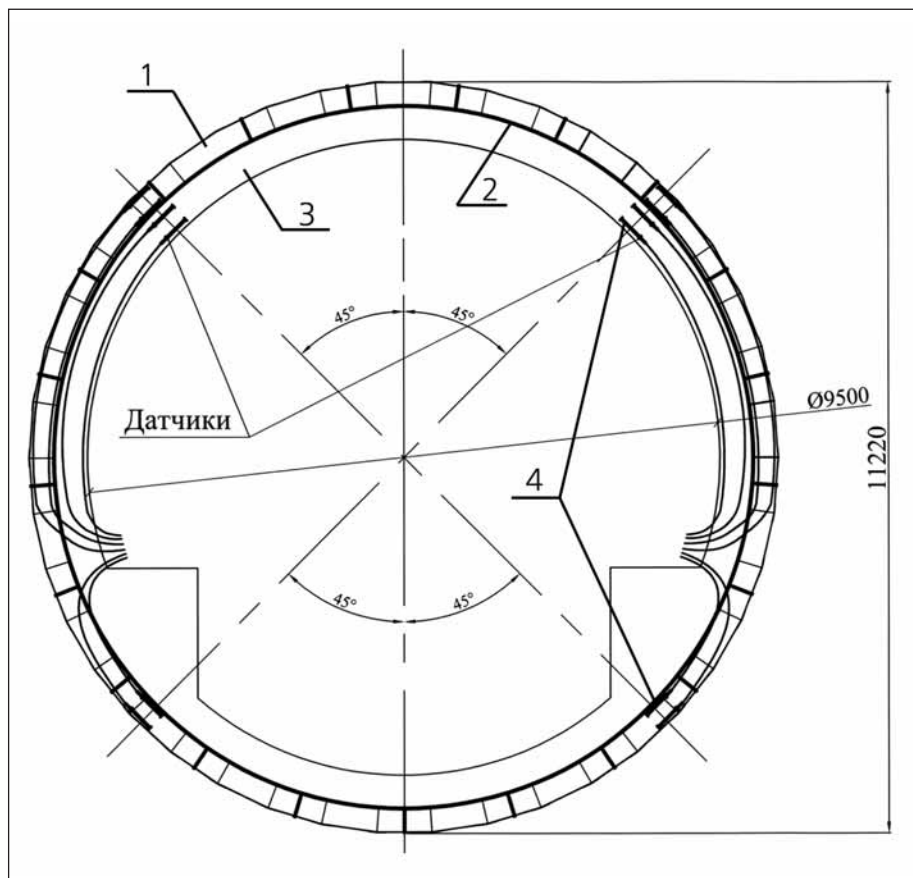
Конструкция крепи и обделки: 1 – аркобетонная крепь, 2 – гидроизоляция, 3 – обделка, 4 – датчики
